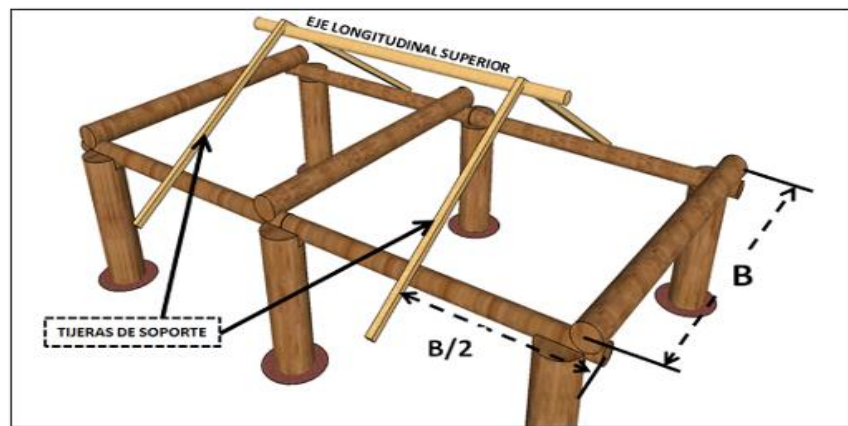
Tijeras del armazón de la cubierta. Fuente: Cuartas (2013).
